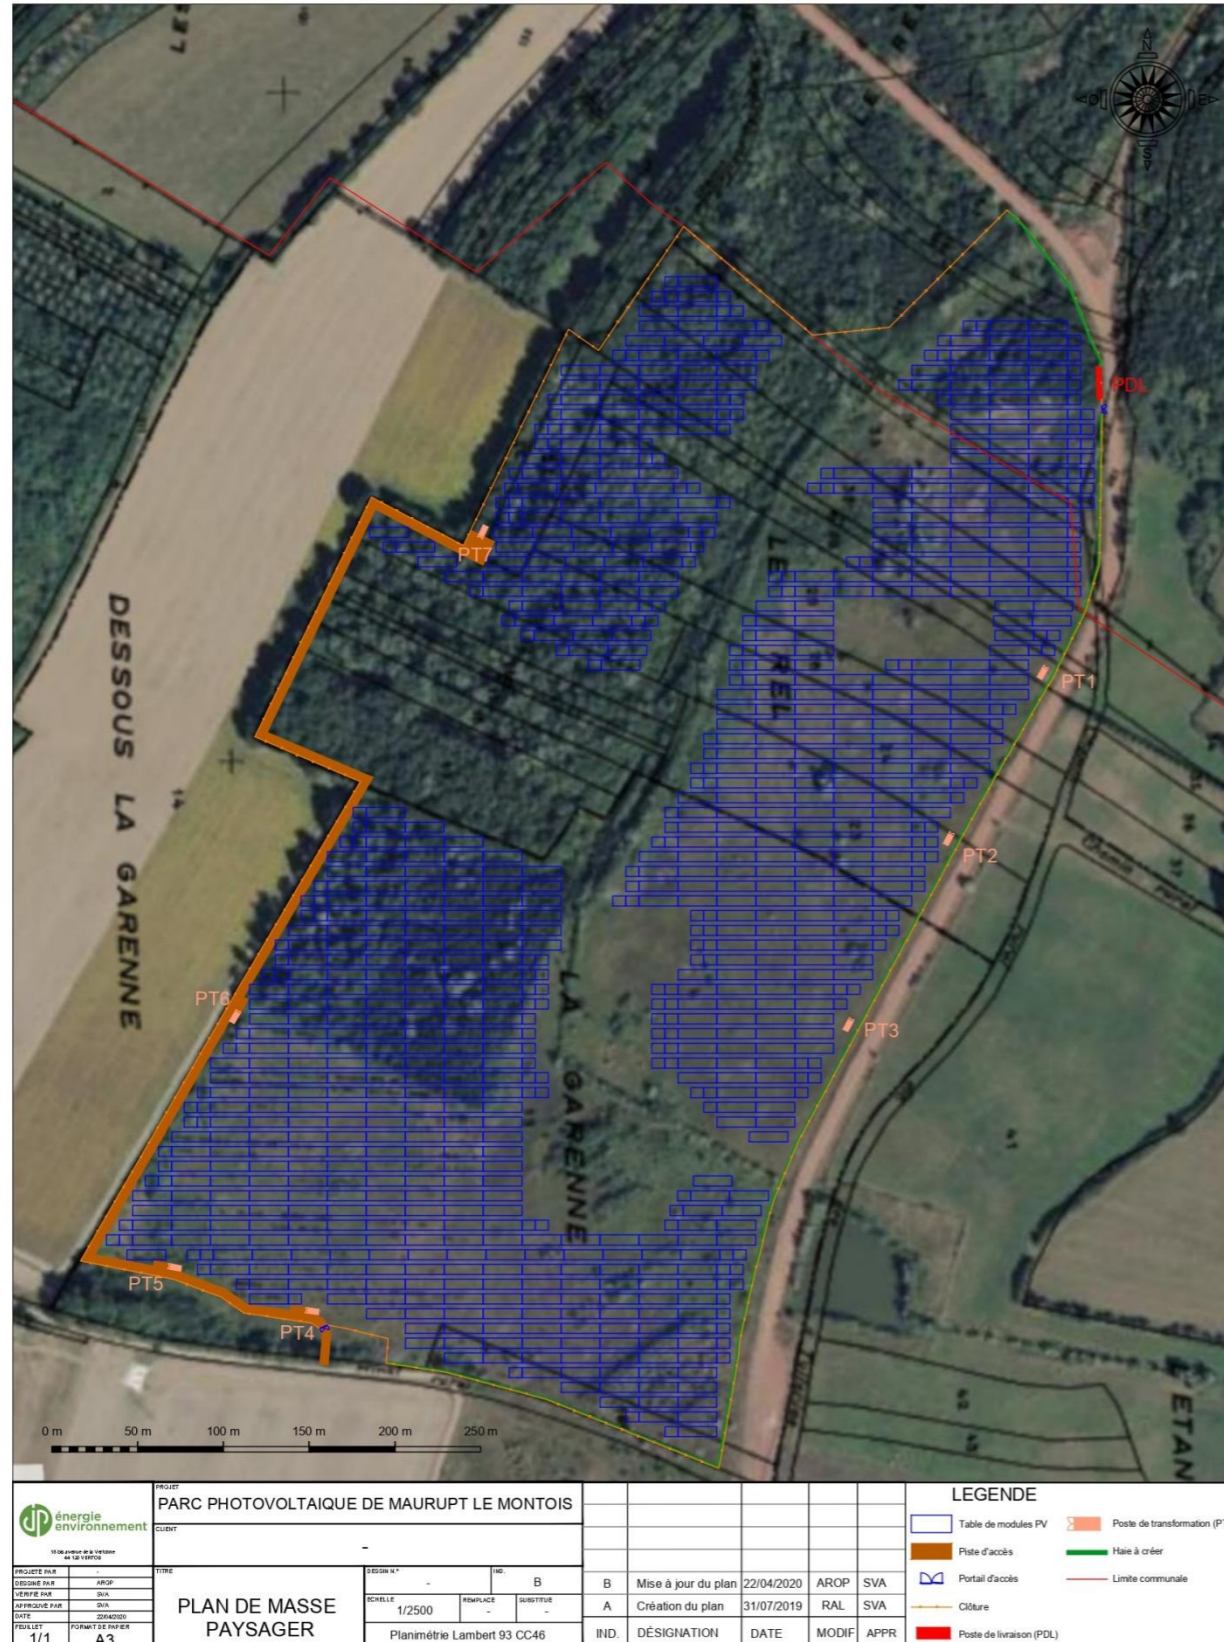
Plan de masse de la version n°4 (variante retenue)
